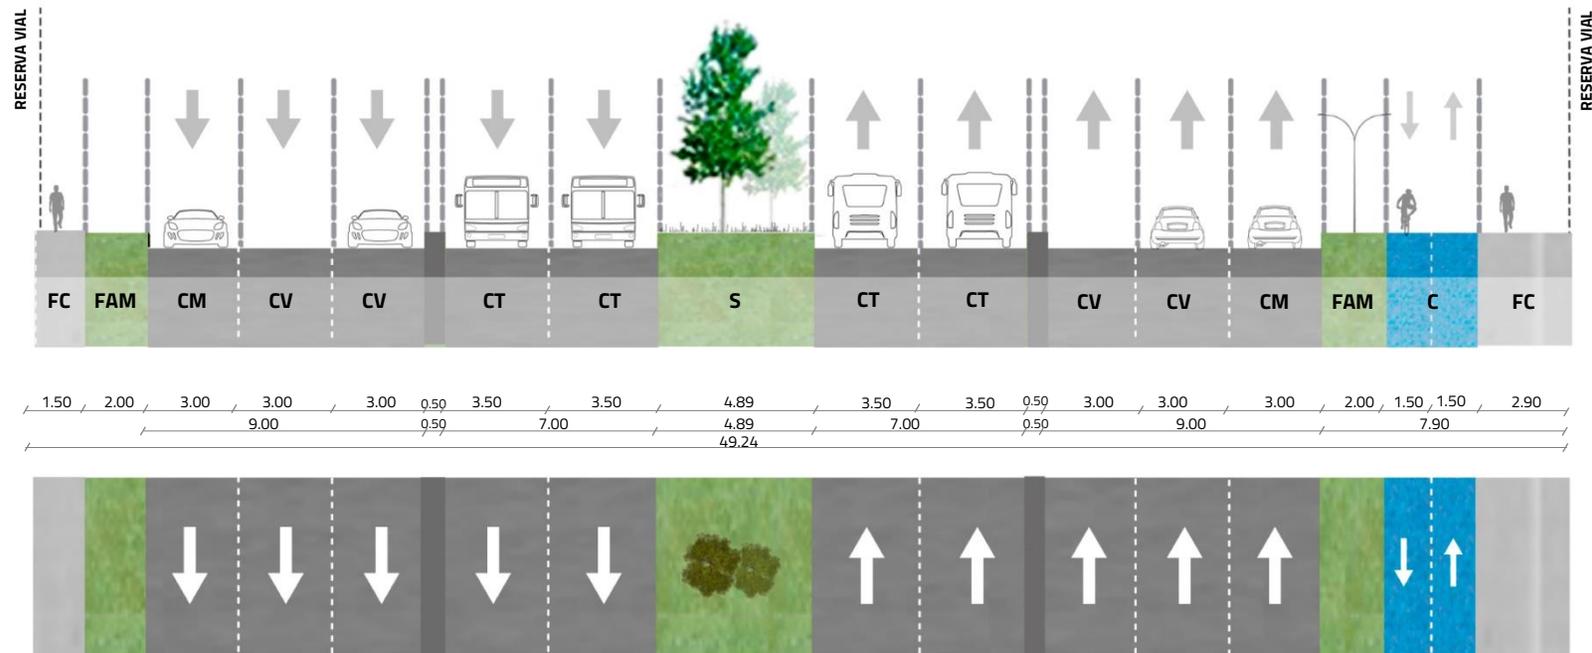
Perfil Av. Colón Calle 13 Fuente: Elaboración Propia
